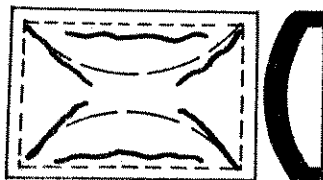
GRIETA POR RETRACCIÓN EN UNA LOSA FUERTEMENTE RESTRINGIDA DE LOS APOYOS.
